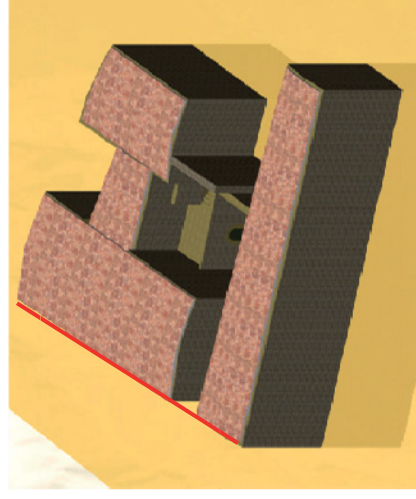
Palazzo Gargallo-Zappata. Ipotesi di ricostruzione piano terra, e primo (pianta PPO)
